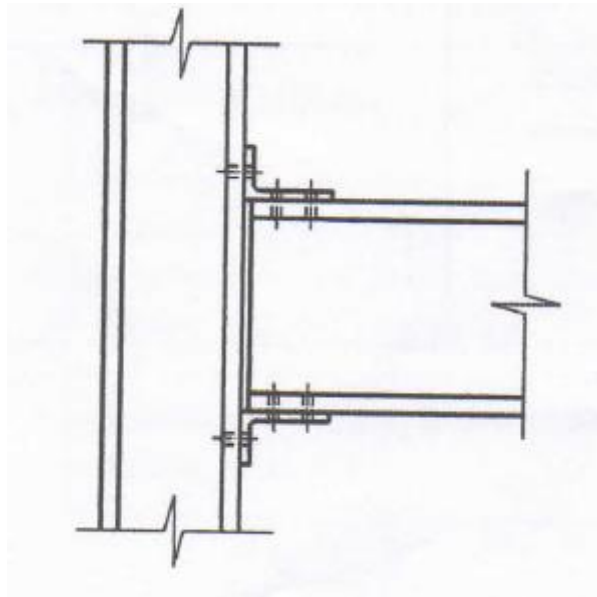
Représentation d'un assemblage poteau-poutre.
